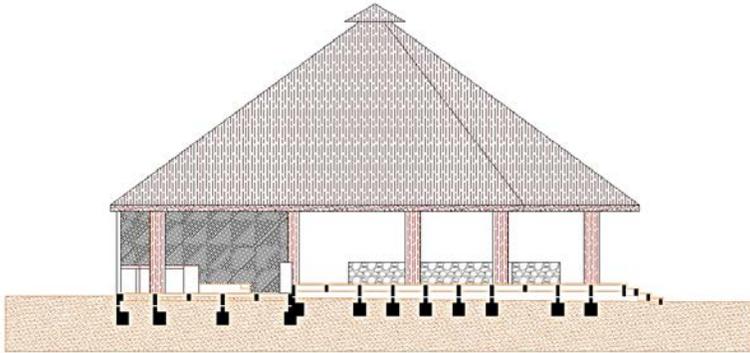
Corte transversal donde se observa el hincado de pilotes con zapatas aisladas para dar soporte al deck de madera. Fuente promovente.
